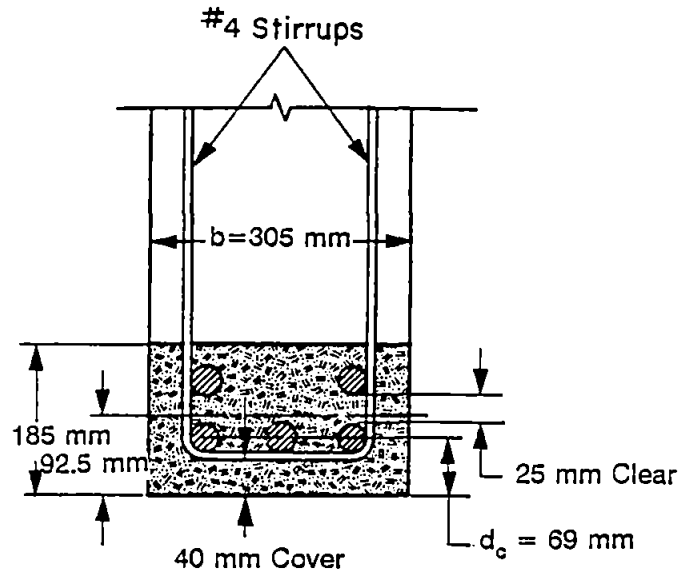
Área efectiva del hormigón en tracción (viga con cinco barras  $\phi 36$ ).
